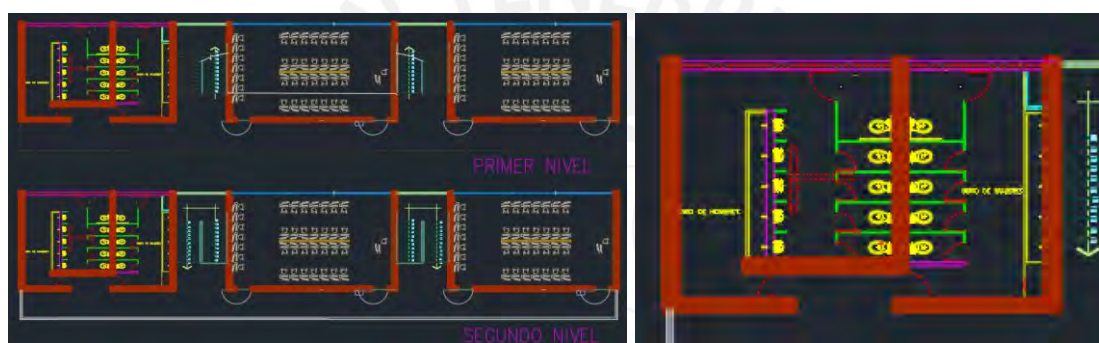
Vistas en planta del pabellón y baños típicos por piso. Fuente: Ramírez, 2020
